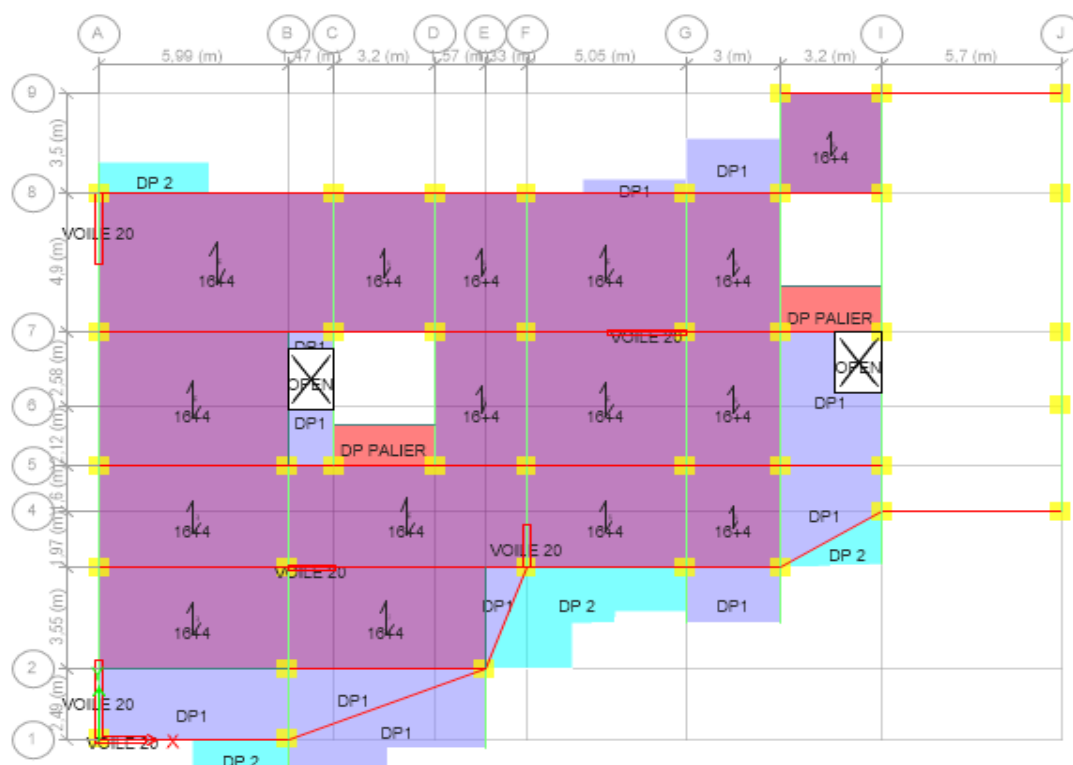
Schéma de la disposition des poutrelles pour le RDC
